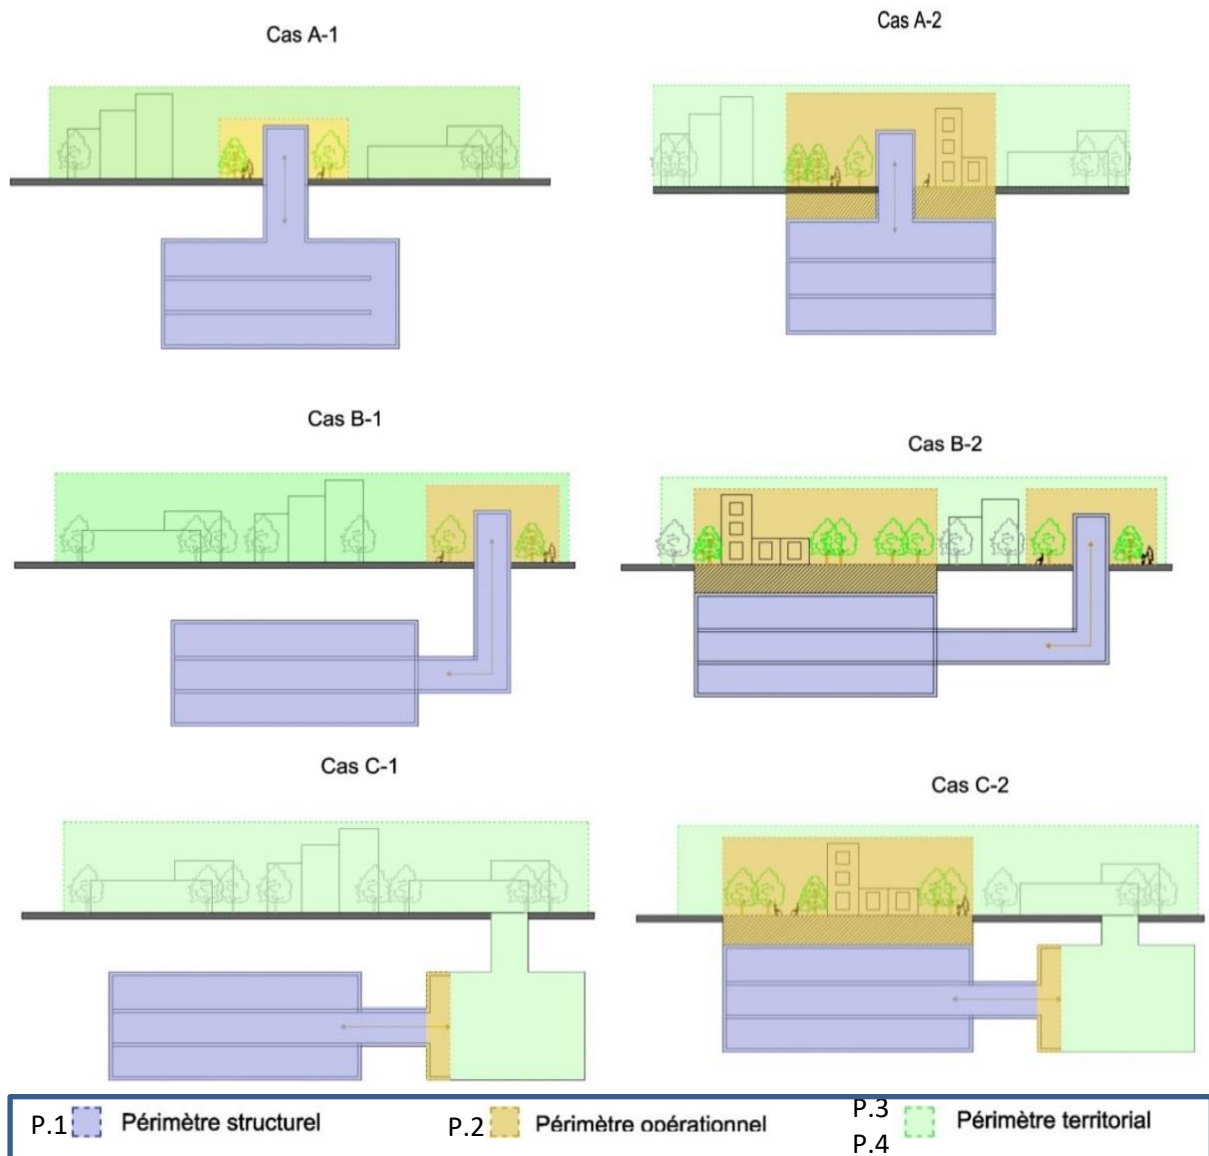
exemples de périmètres spatiaux pour un ouvrage souterrain suivant l'accès et la méthode de construction
